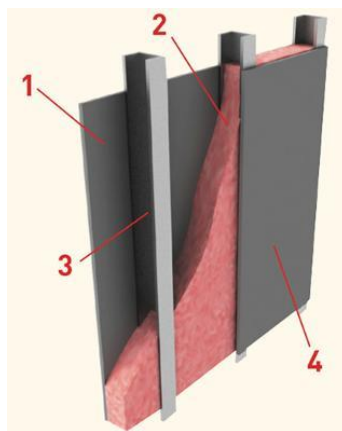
Утепленная перегородка: 1, 4 – листы из гипсокартона, 2– тепловая изоляция, 3 – каркас из металлического профиля
